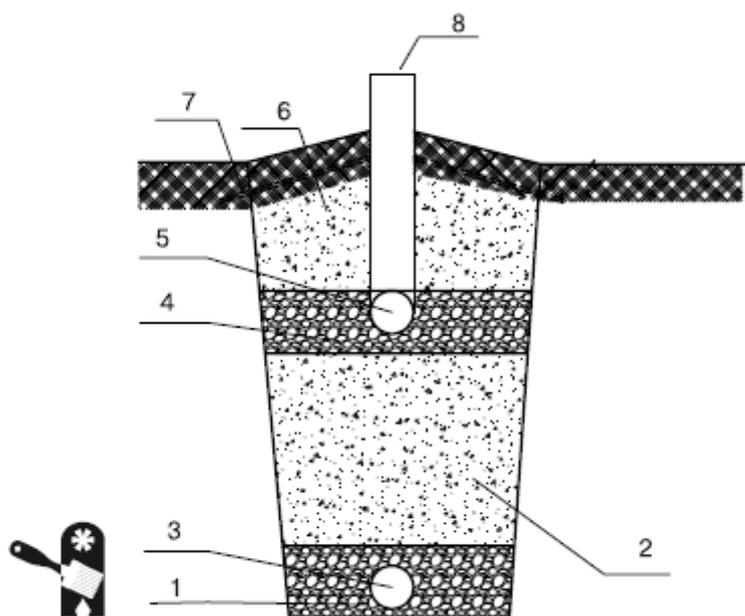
Фильтрующая траншея: 1 – нижняя гравийная подушка; 2 – крупнозернистый песок; 3 – нижняя дренажная труба; 4 – верхняя гравийная подушка; 5 – верхняя дренажная труба; 6 – насыпной грунт; 7 – гидроизоляция; 8 – вентиляционный стояк
